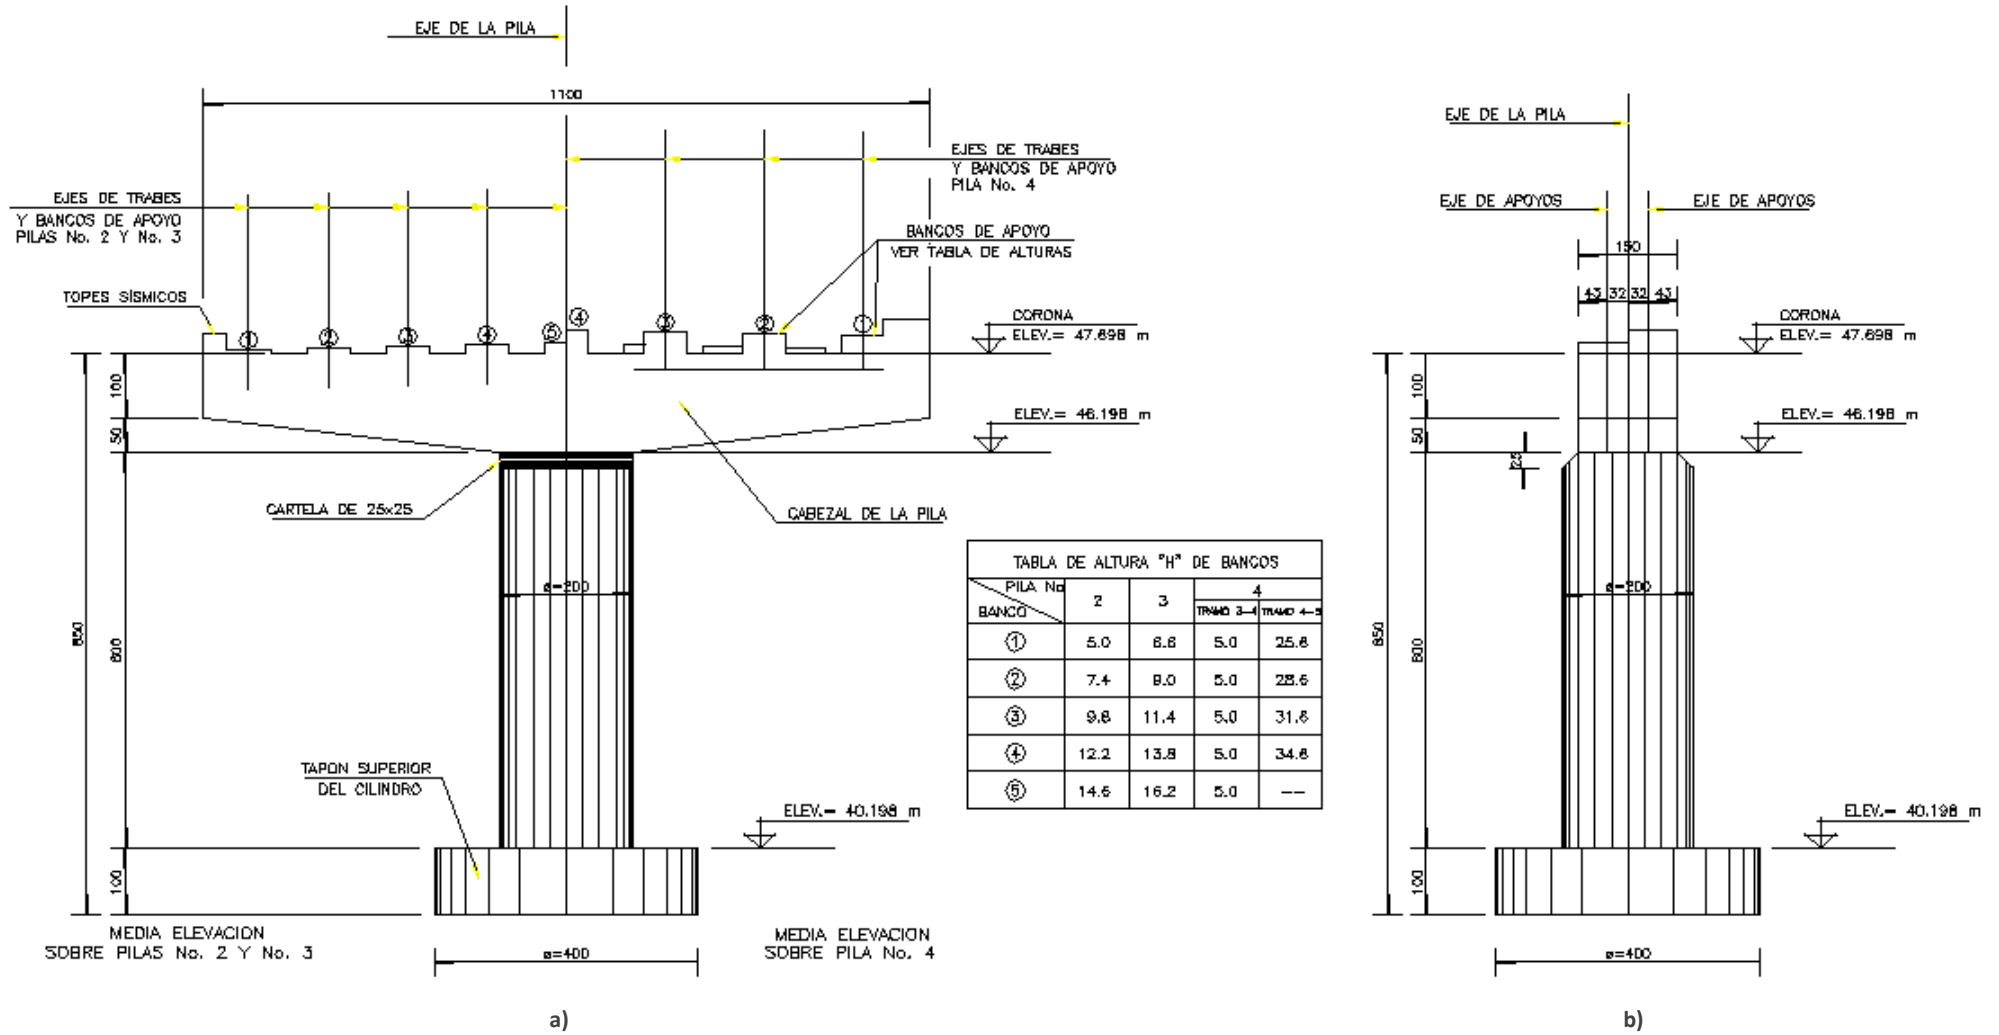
Detalle de las pilas adicionales del puente Las Adjuntas: a) Elevación frontal y; b) Elevación Lateral. (Sin escala, cotas en cm).
